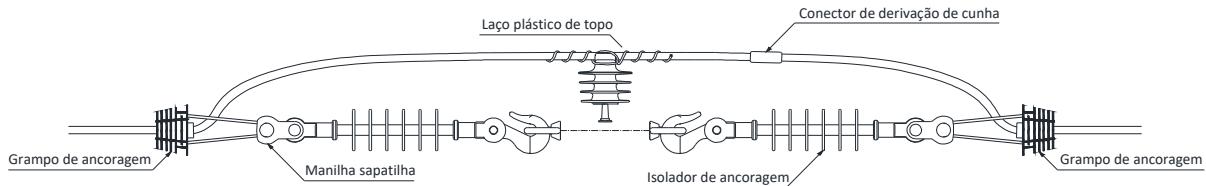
Amarragens e ligações – Ancoragem dupla – Cabo protegido
